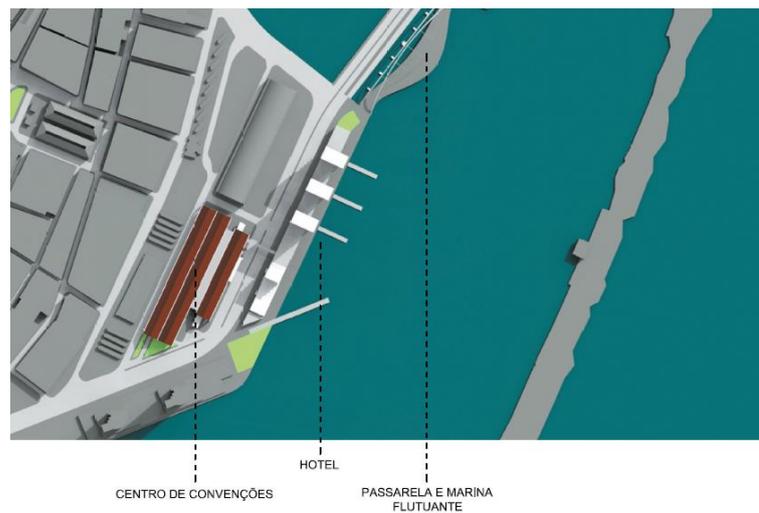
Planta do centro de convenções, hotel, passarela e marina.
